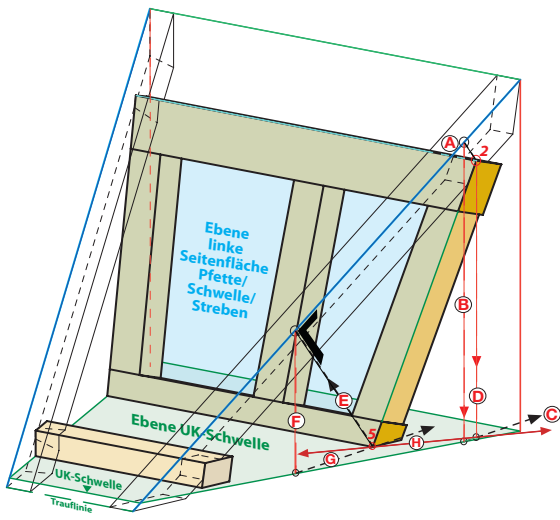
Ermittlung der Abschnittskante 5 – 2 im Grundriss
